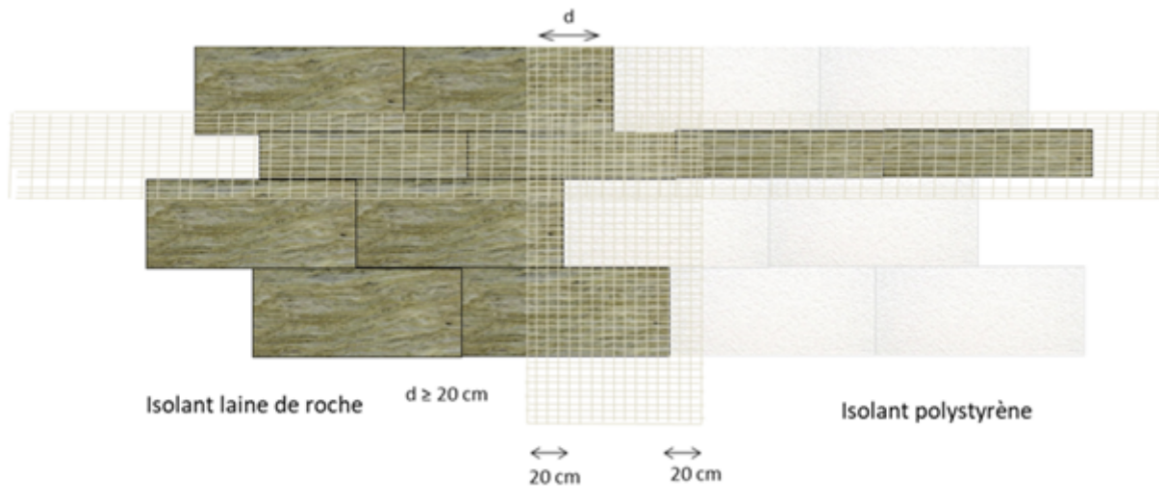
Système StoTherm Brick LDR avec panneaux en laine de roche de dimensions 600 x 1200 mm
